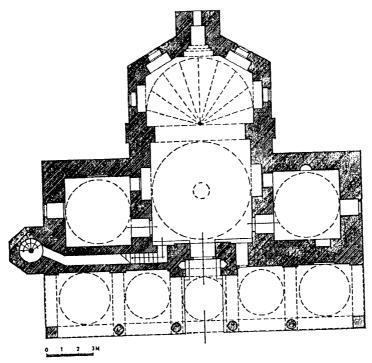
مسقط أفقي وقطاع لعمارت غازي أورنوس بك في كوموتيني باليونان) (عن : Bakirtzis etxydas) .
